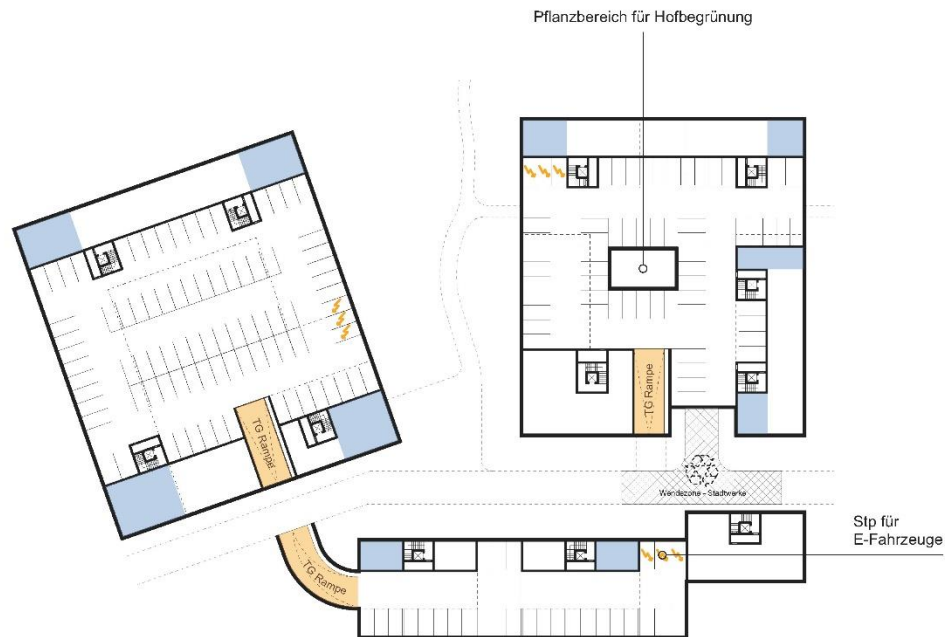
Rahmenplanung | Unterirdische Parkierung © LECKE ARCHITEKTEN
